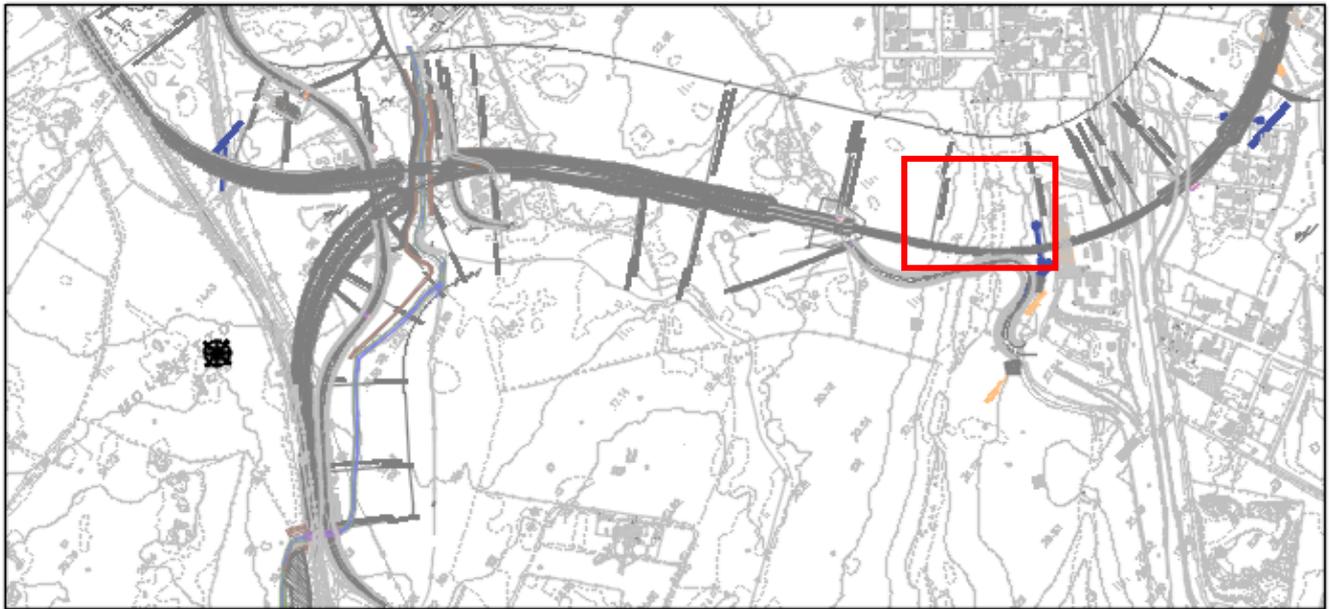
Planimetria di progetto ed individuazione del tratto in galleria naturale
